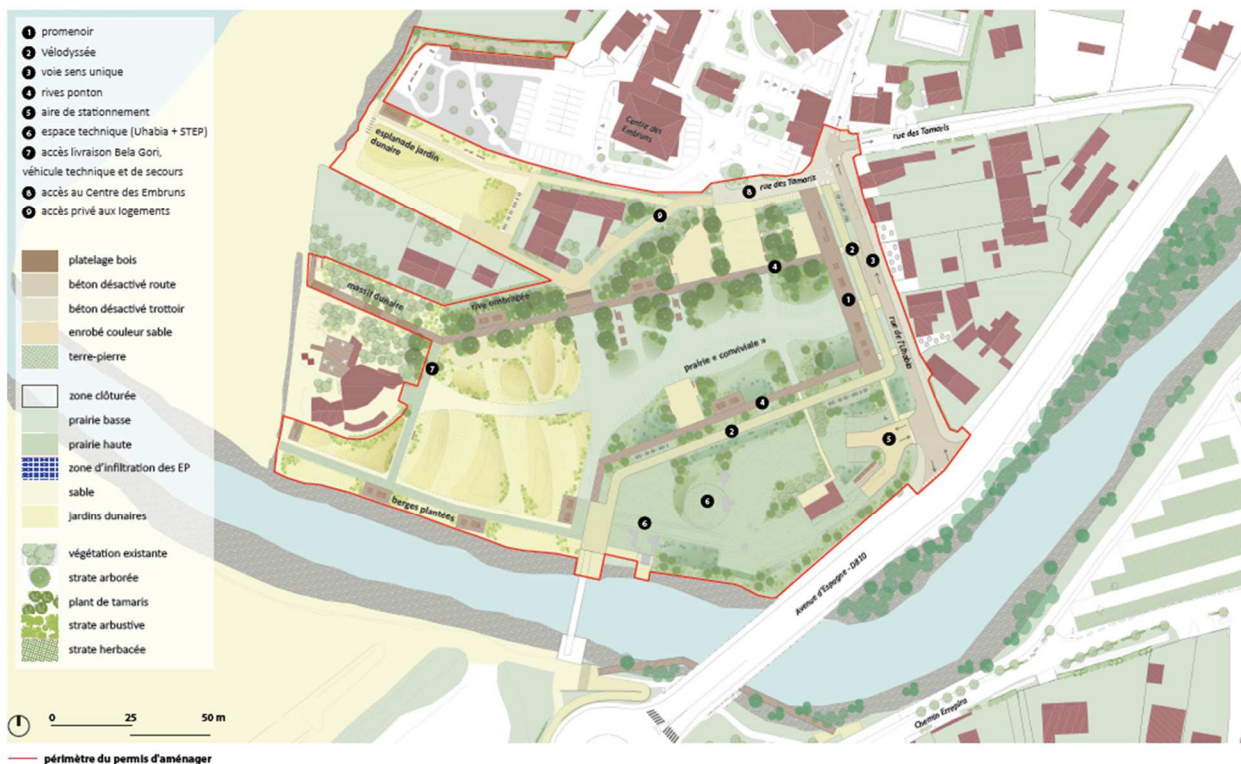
Plan de masse du projet d'aménagement prévu sur l'Esplanade des Embruns, la Place Verte et Bleue et les rues attenantes (source : Notice du Permis d'Aménager, Les Marneurs, 2024)
